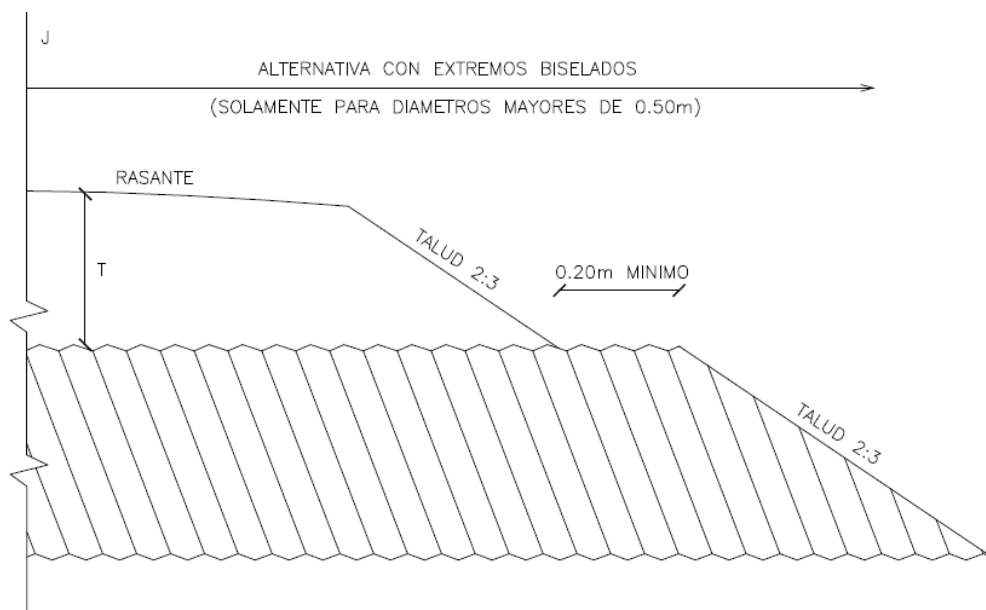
Detalle de extremo Biselado alcantarilla H-10209
